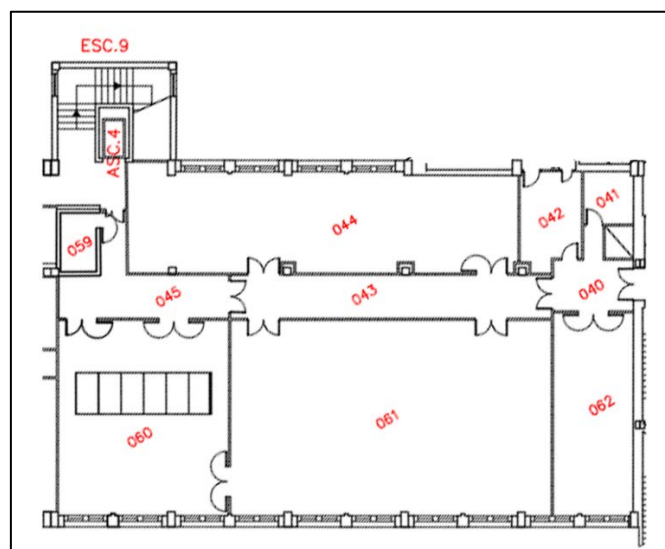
Detalle Plano de la sala de disección e instalaciones asociadas
